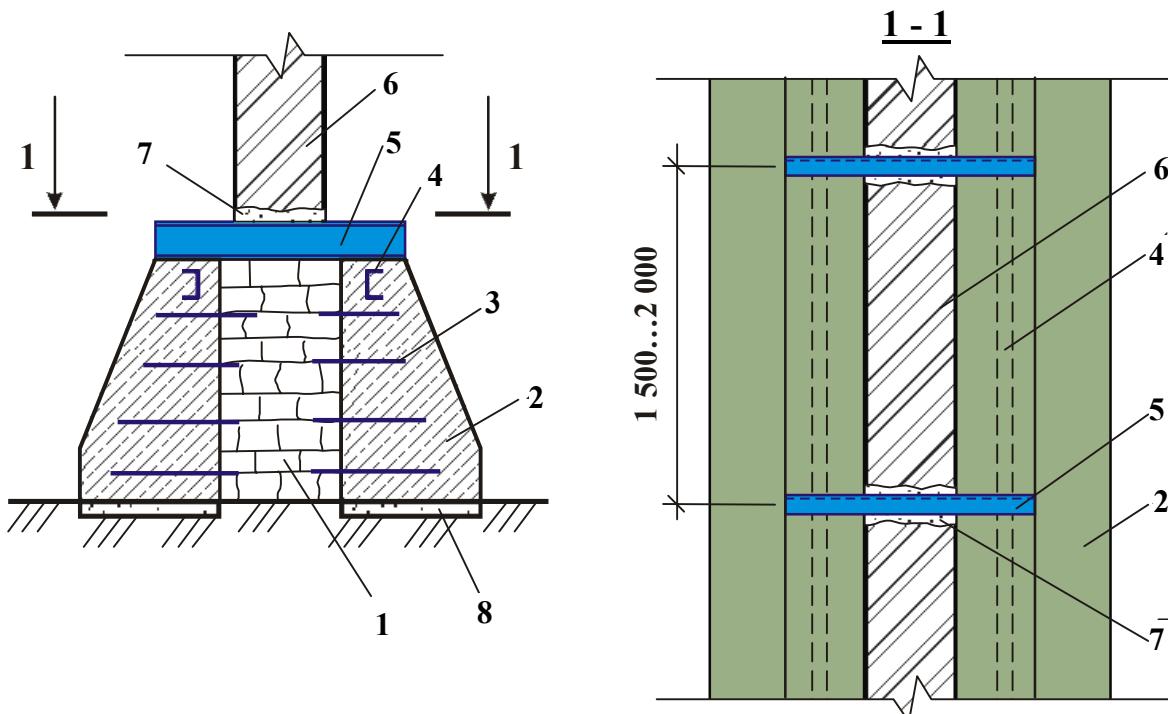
Підсилення фундаментів монолітними бетонними банкетами:
